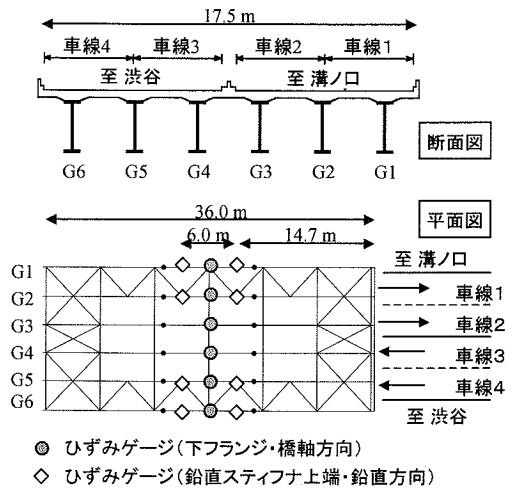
玉川高架橋の断面図・側面図とひずみゲージ位置
